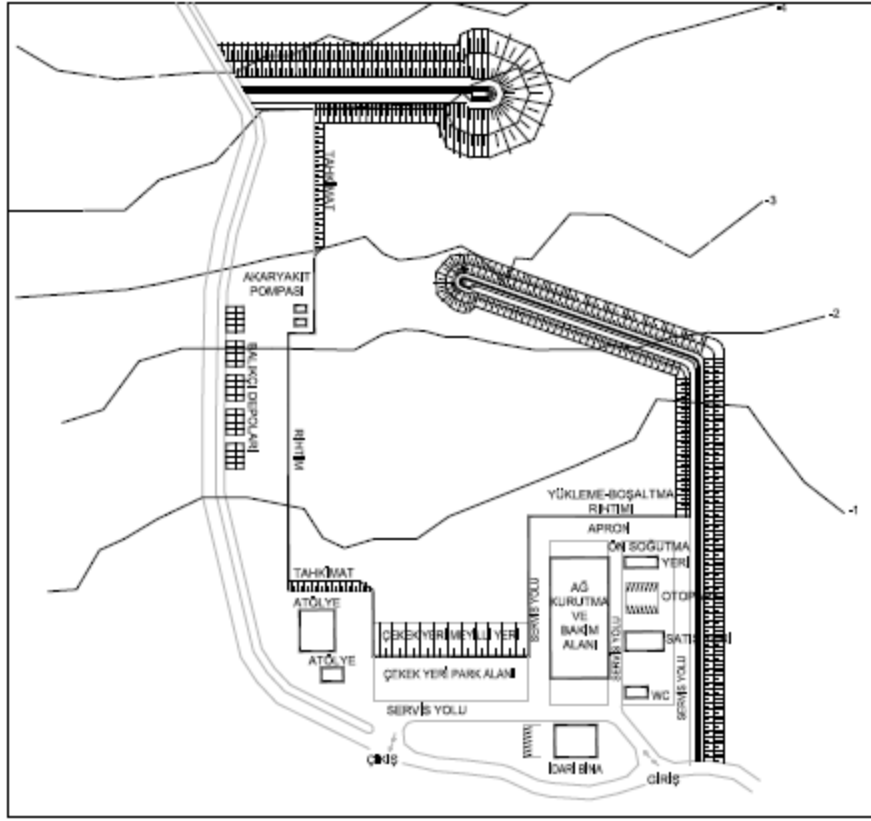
Tipik bir barınma ve çekek yeri yerleşim planı (UDHB, 2011)
